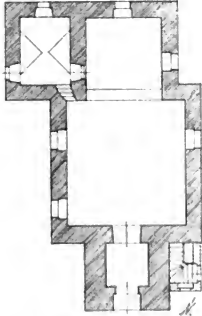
Lang-Lhota. Grundriss der Kirche.
